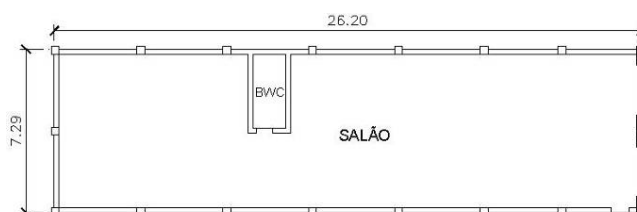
Planta baixa do galpão da construção com vão superior a 7,0 m.
